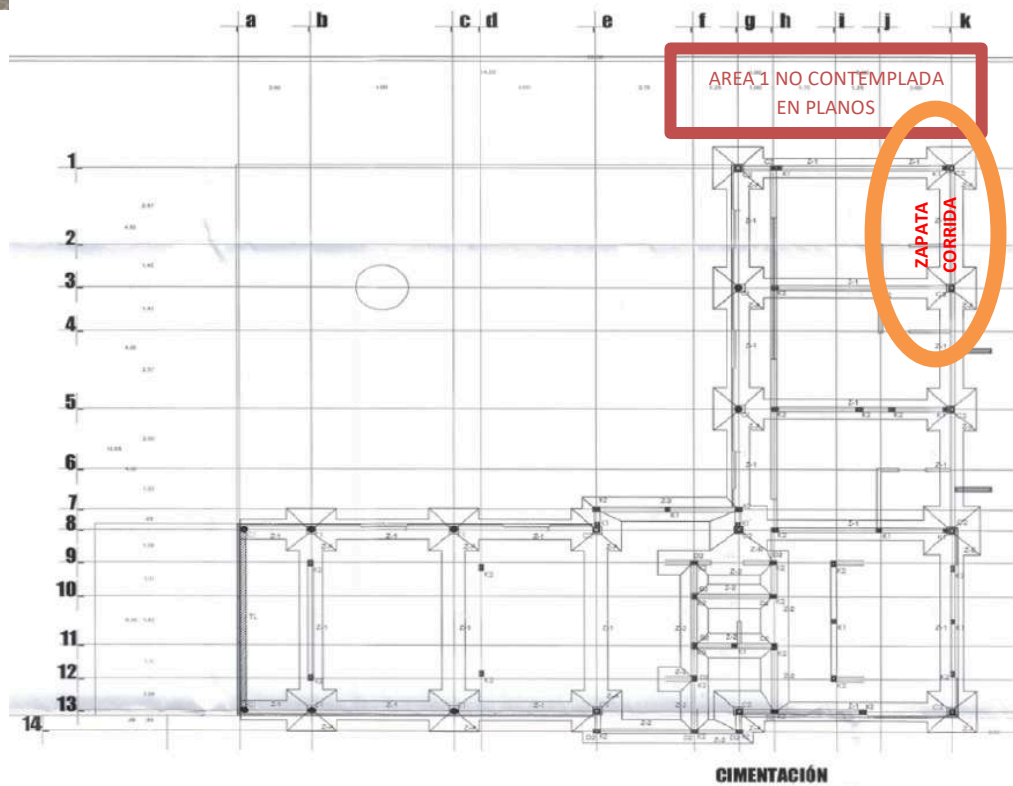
Planta de cimentación ejecutada en obra contra planta de cimentación propuesta.
